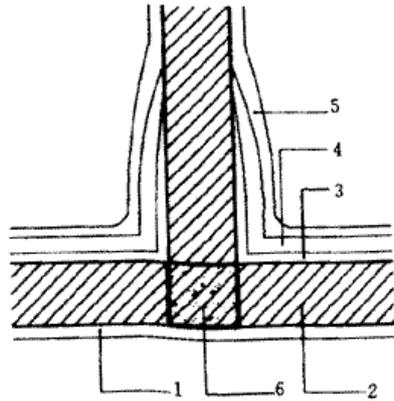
丁字墙（带混凝土外柱）内保温做法
